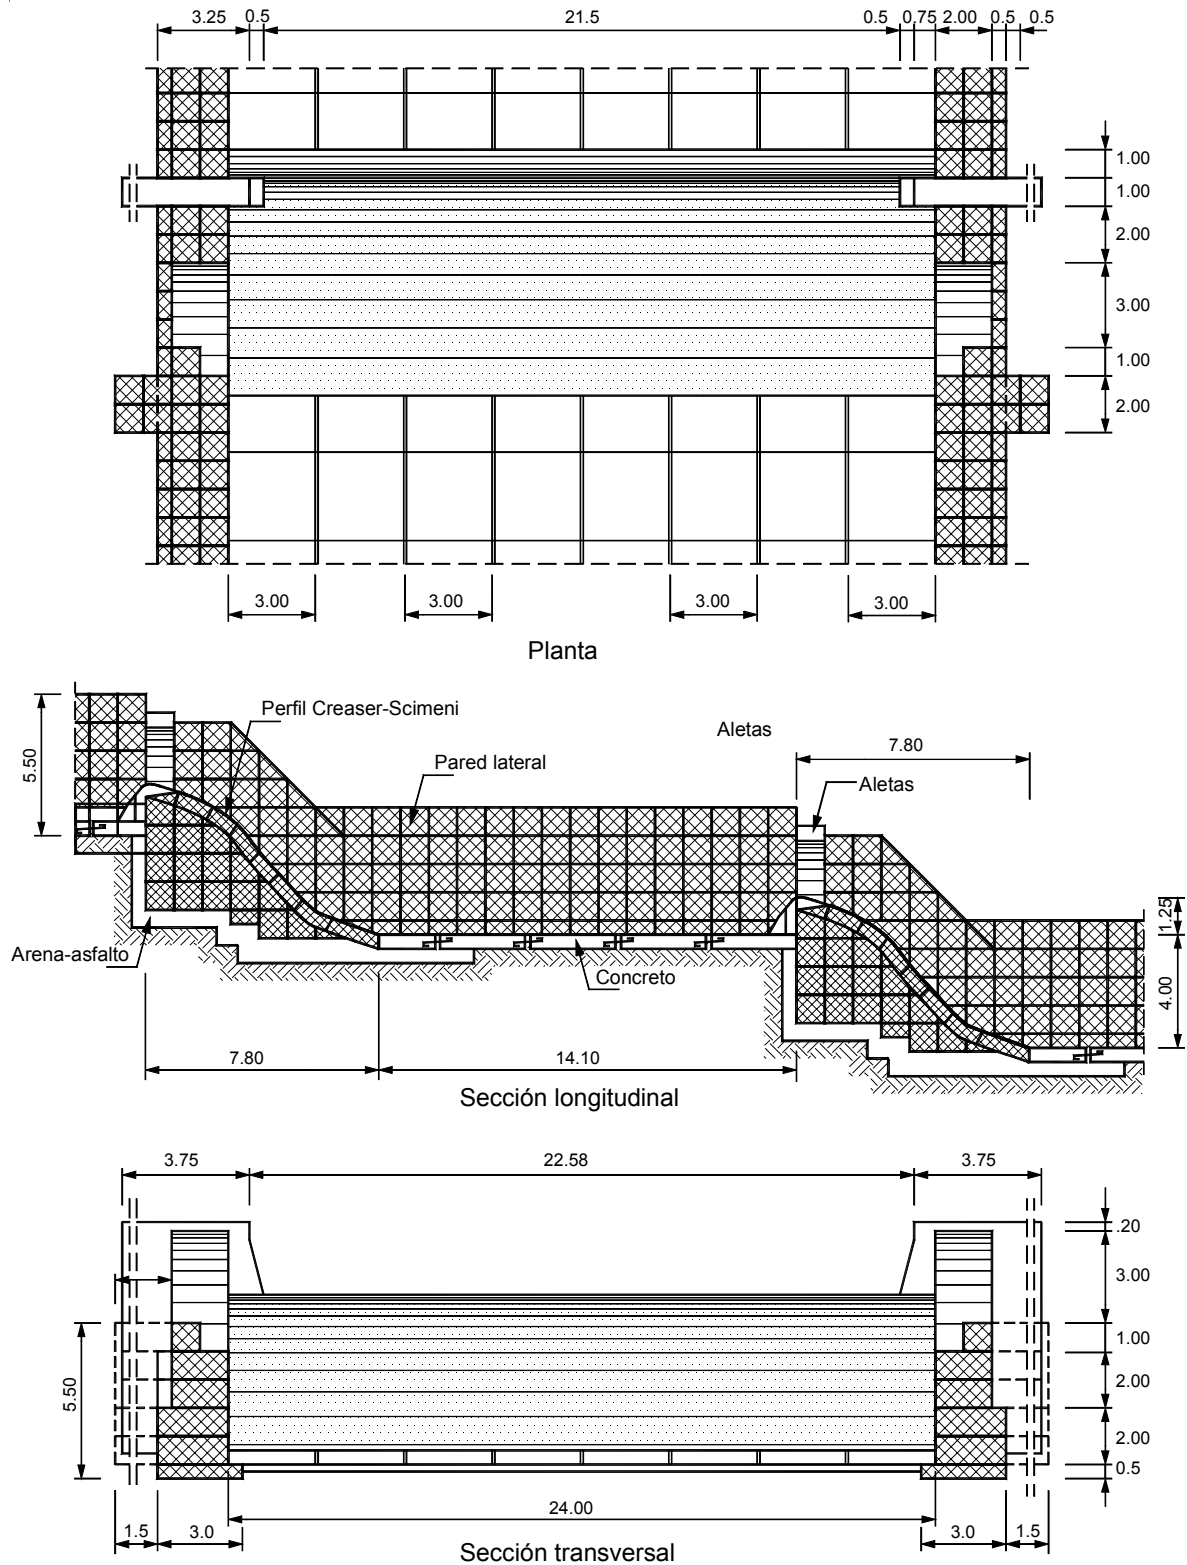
Detalle de vertedero en gaviones con sección inclinada.
